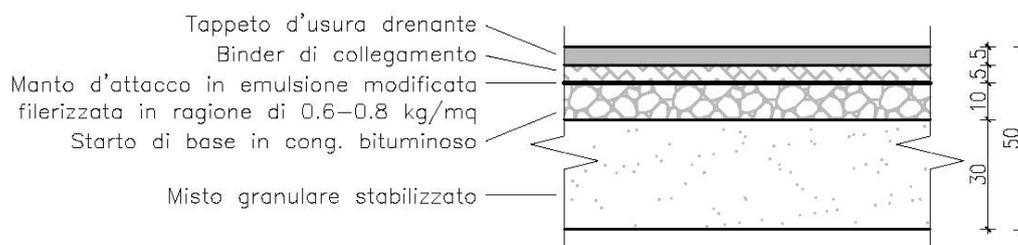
Caratteristiche degli strati che comporranno la pavimentazione stradale
